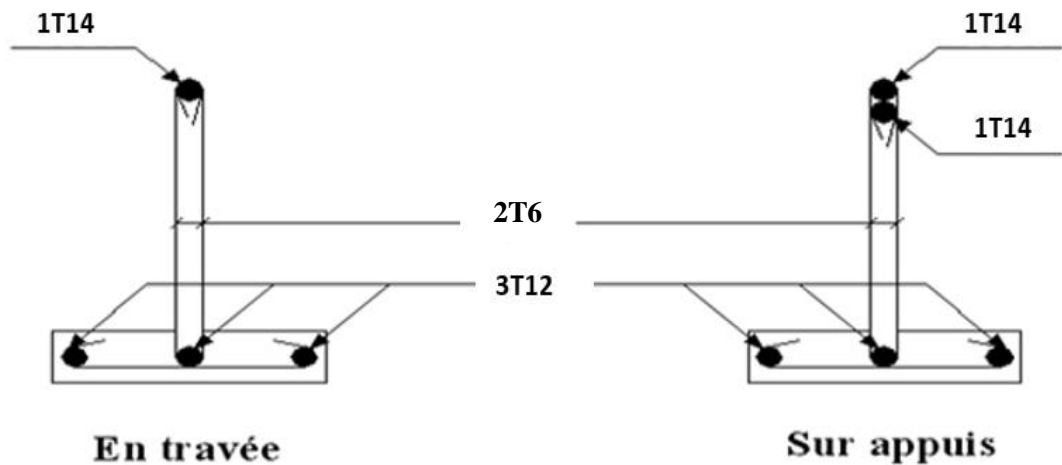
ferrailage des poutrelles en travée, et en appuis
